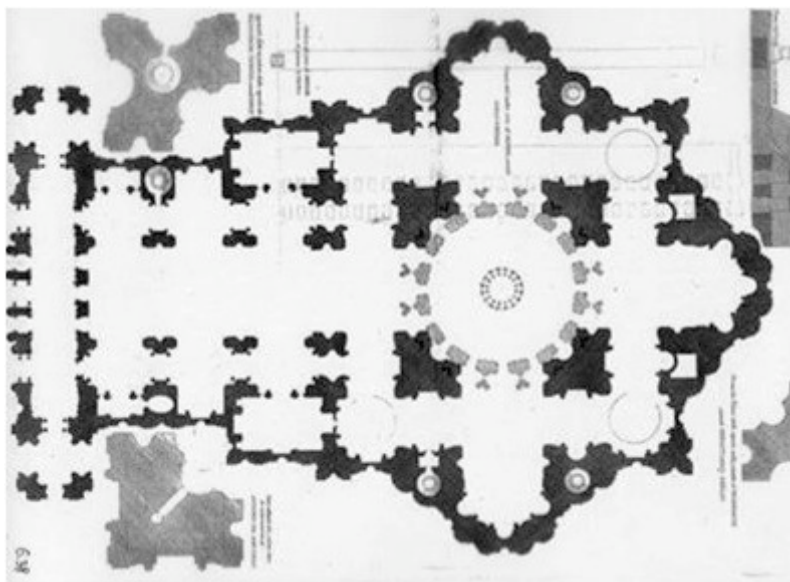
Planimetria di San Pietro nei disegni di Giuliano da Sangallo.
